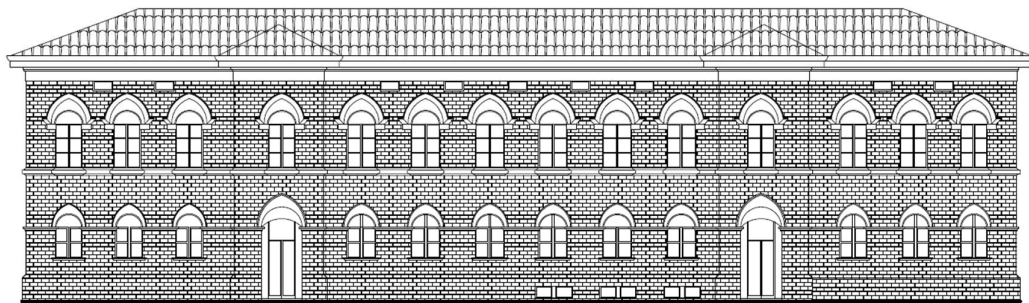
Prospetto B (precedentemente definito Sud o di monte)
